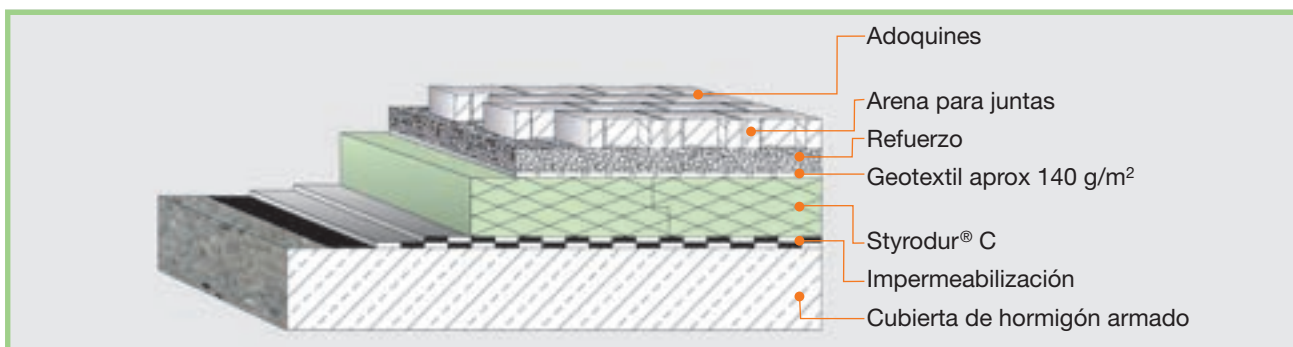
Creación de un aparcamiento sobre cubierta con adoquines sobre un refuerzo.
